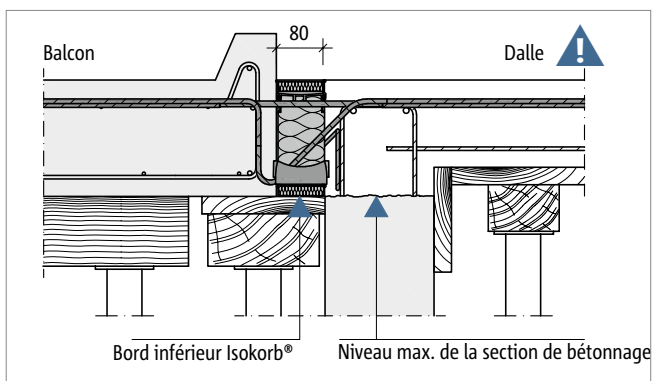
Schöck Isokorb® T Type K-E, K-T : Balcon préfabriqué complet avec plancher décalé en hauteur sur mur en béton
